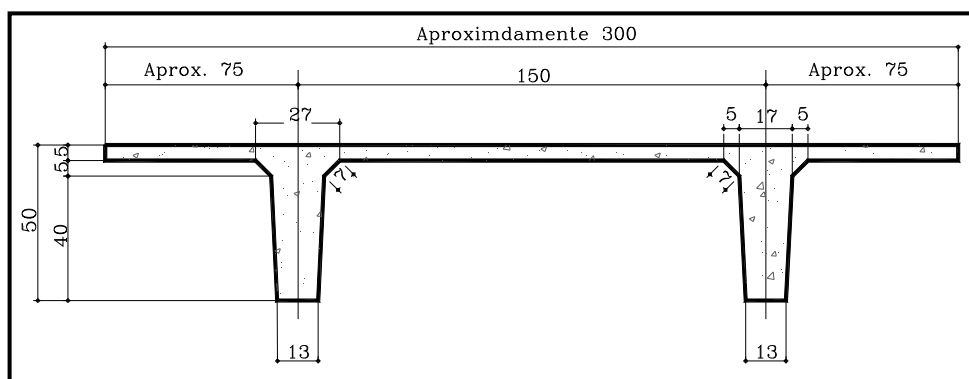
Sección de viguetas de concreto para losa de entrepiso y azotea, cota en cm.
